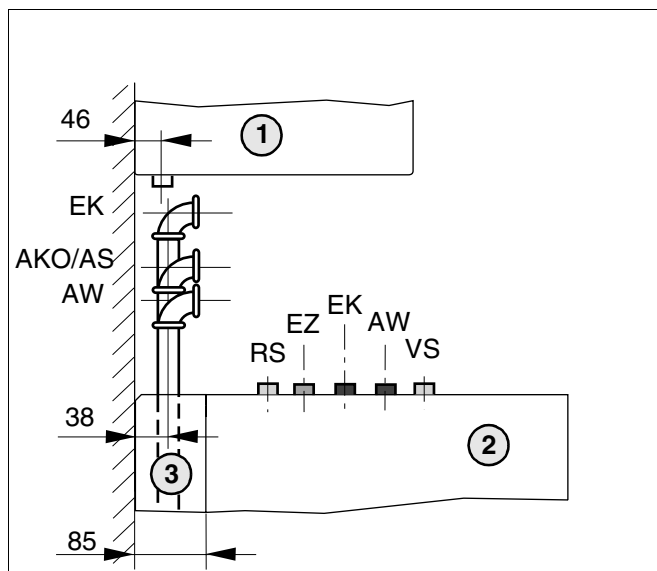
Abmessungen der Hydraulikanschlüsse S135/S160, Aufputzmontage (Seitenansicht)
